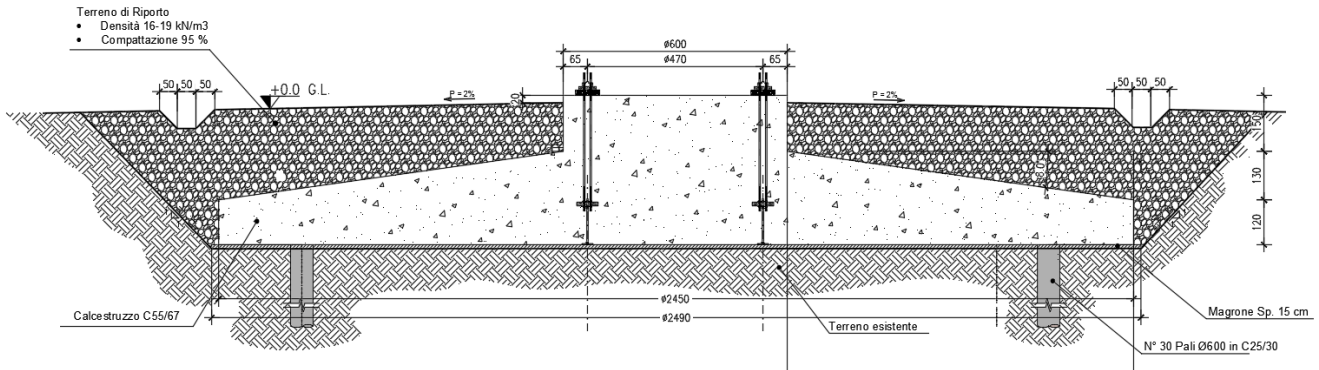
Tipico fondazioni aerogeneratore. Estratto elaborato
